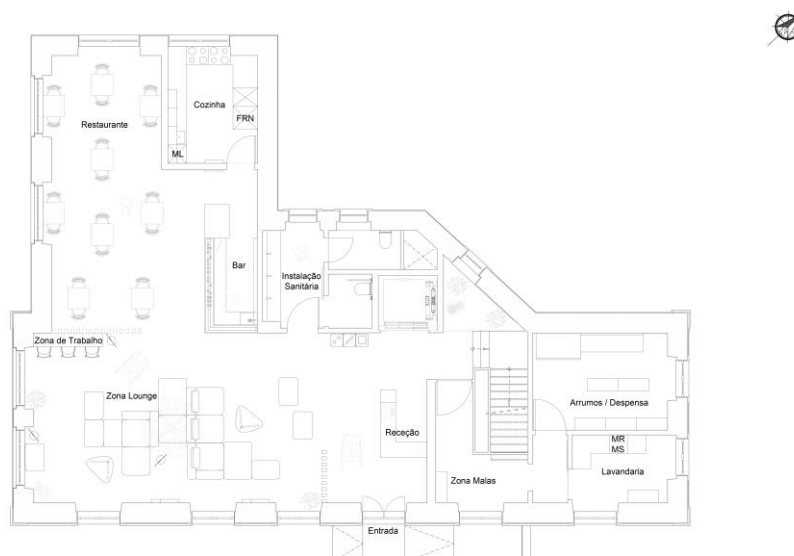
Planta de Zonamentos Piso 0. Fonte: Autor
